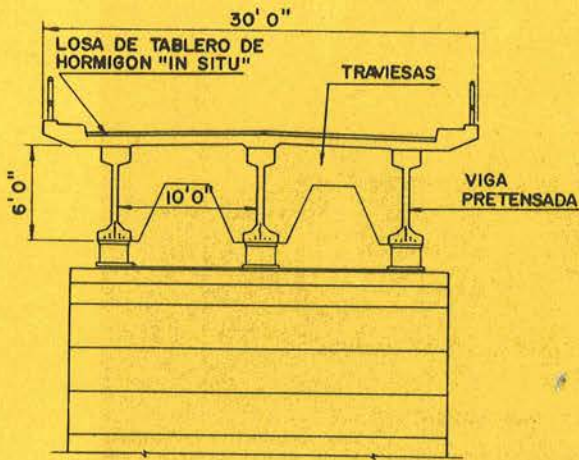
Pueno de Jackdgergery. Sección transversal del tablero.
